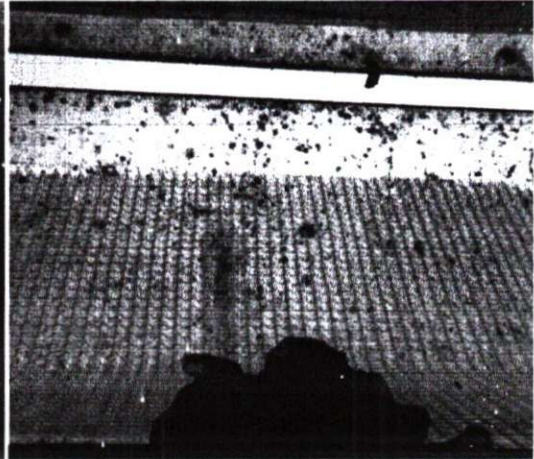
Sudut Lantai Ruangan Berkarat
